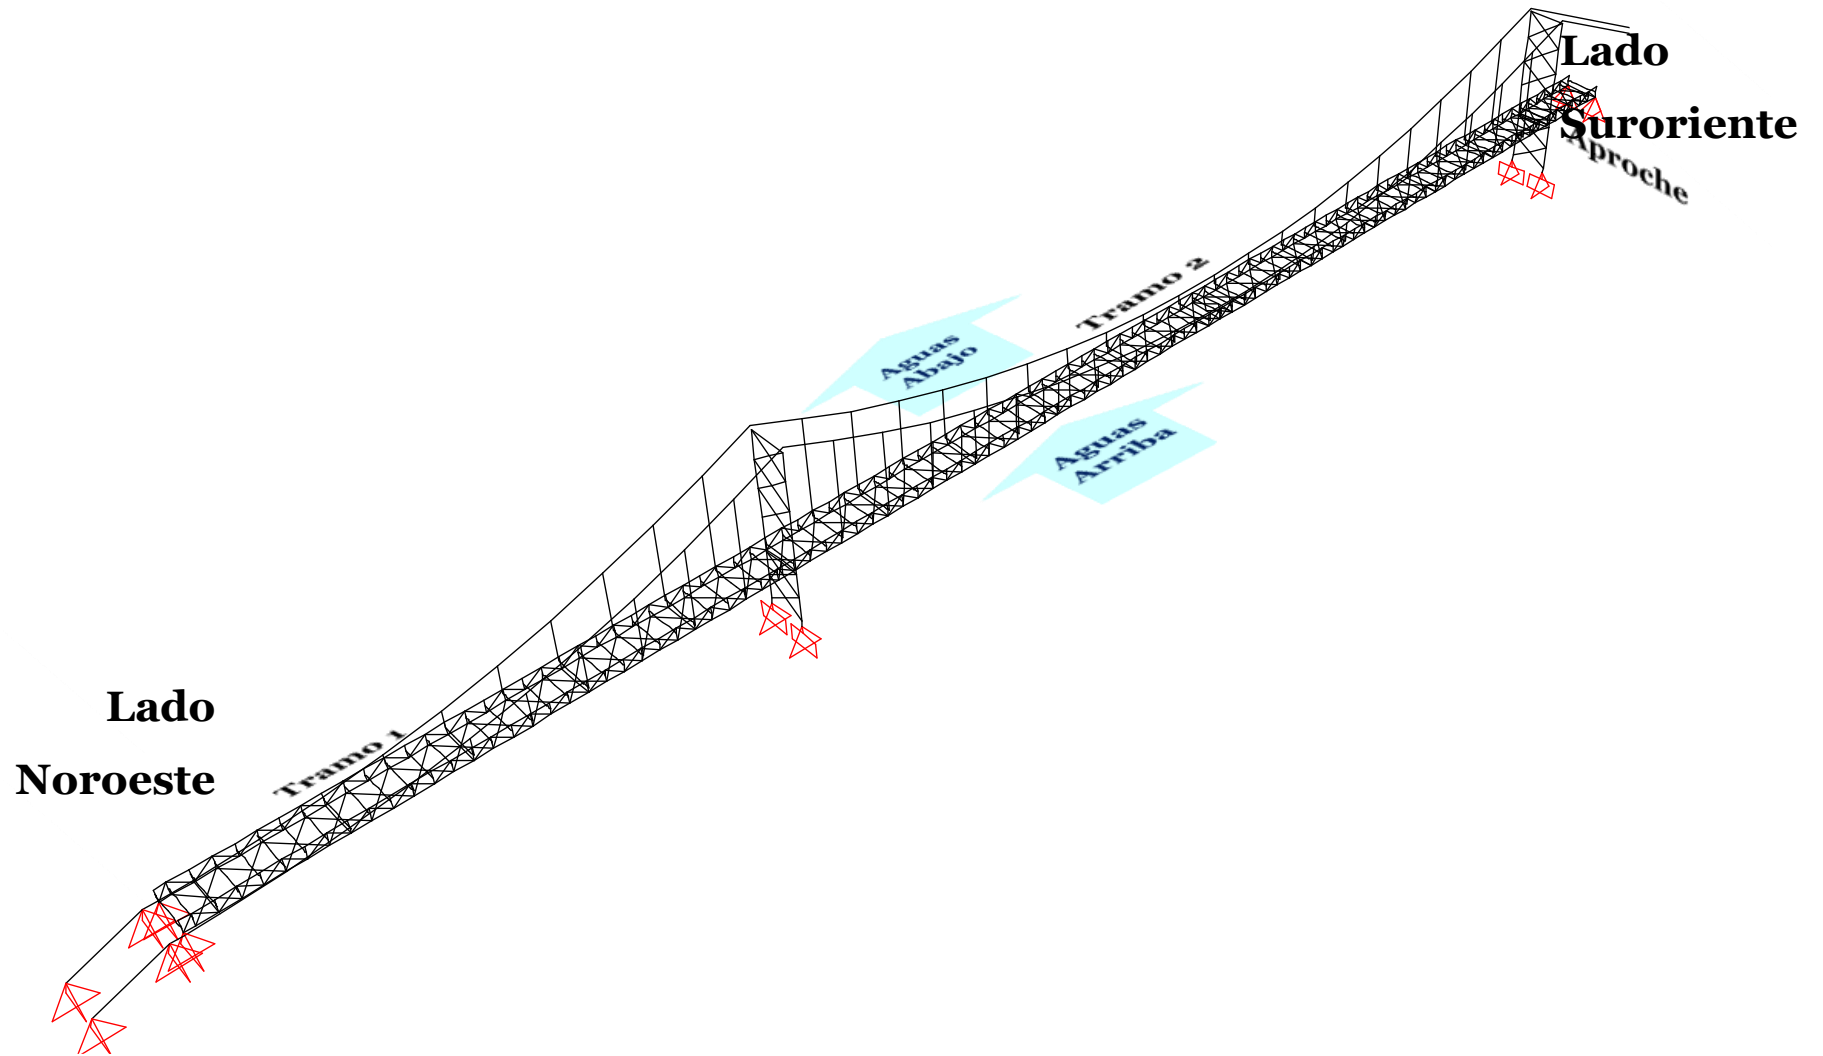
Modelo estructural del puente – Vista 3D General.
